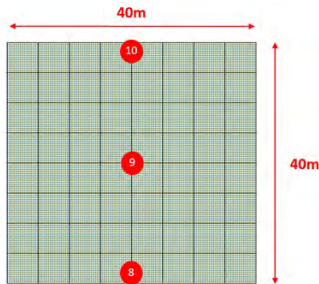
第1施工区の資材配置状況とサンプル採取地点概略
